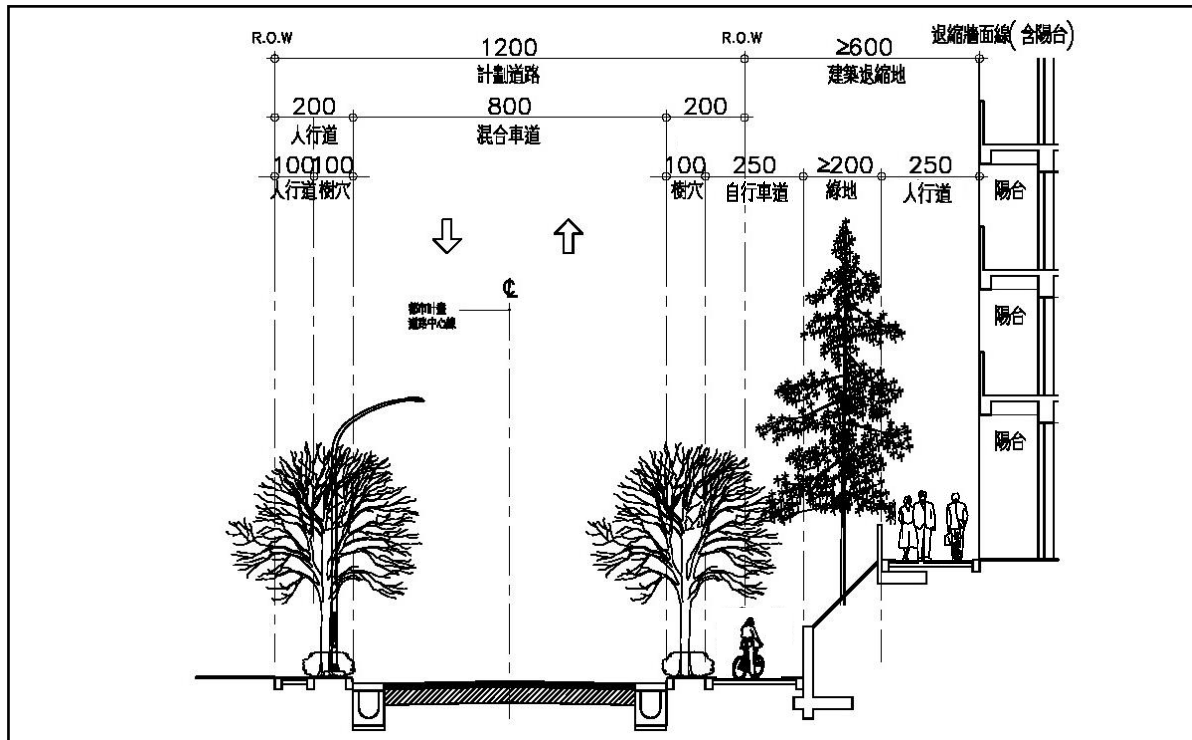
建築基地臨道路退縮空間配置示意圖 (二)
